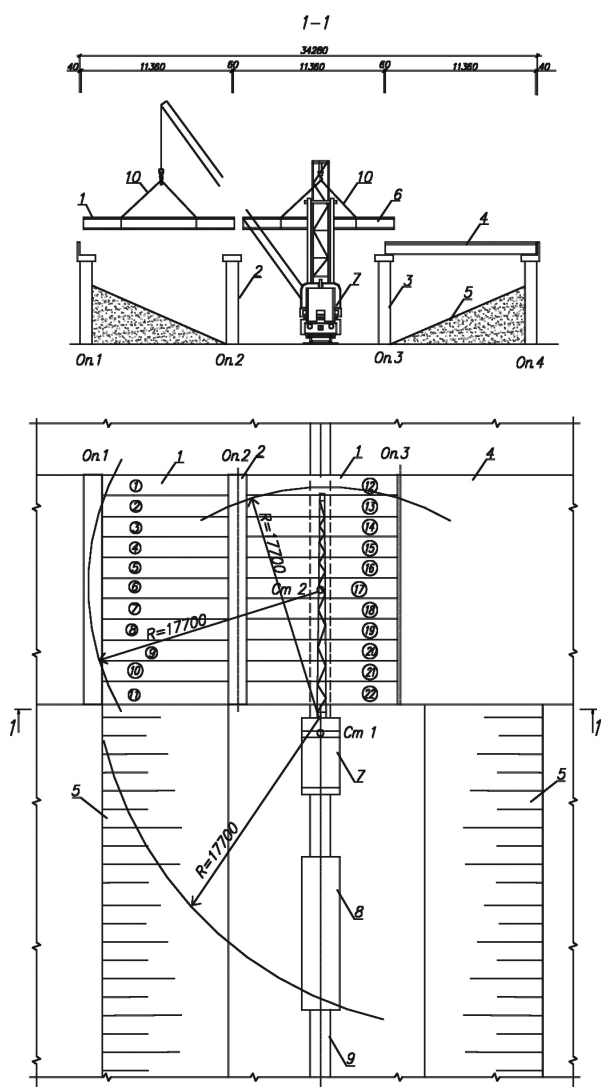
Монтаж балок ПС: 1 – балки пролета 1-2; 2 – опора № 2; 3 – опора № 3; 4 – балки пролета 3-4; 5 – откосы; 6 – монтируемая балка; 7 – кран железнодорожный; 8 – грузовая ж/д платформа; 9 – ж/д пути; 10 – строп; ①-②② – порядок демонтажа балок ПС
